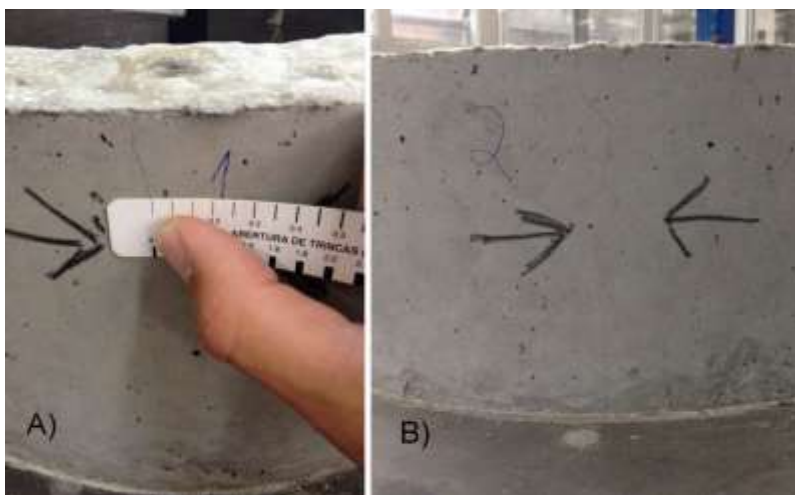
Fissuração da amostra CFU 02 do concreto reforçado com fibra de poliéster usada
